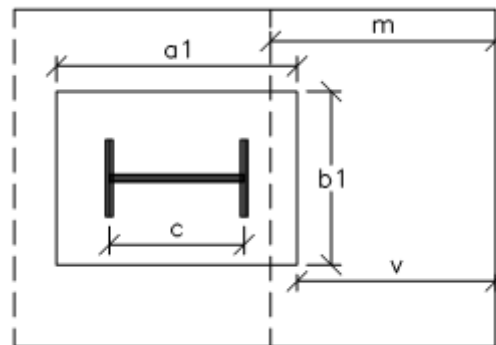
Vuelo de cálculo en una zapata con pilar metálico.
